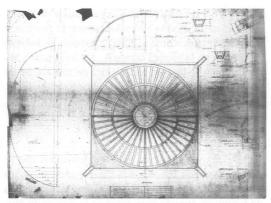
Planta, sección y detalles de la estructura de la cúpula del pabellón de baile (Archivo personal de Vittorio Garatti)
